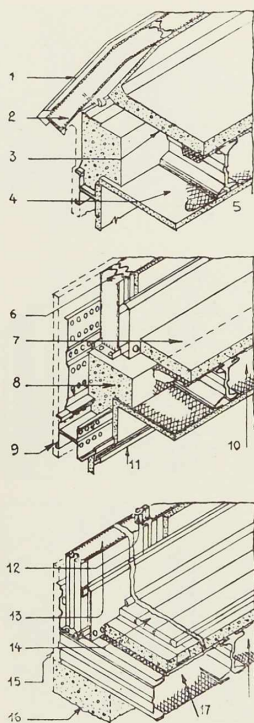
LÉGENDE. Revêtement de toiture d'un type quelconque. 2. Élément de toiture préfabriqué. 3. Dalle en béton. 4. Élément de plancher préfabriqué. 5. Plancher de mansarde. 6. Montant métallique. 7. Plancher d'un type quelconque. 8. Treillis métallique rempli de béton. 9. Revêtement du mur. 10. Élément de plancher préfabriqué. 11. Moulure pour tableaux.
